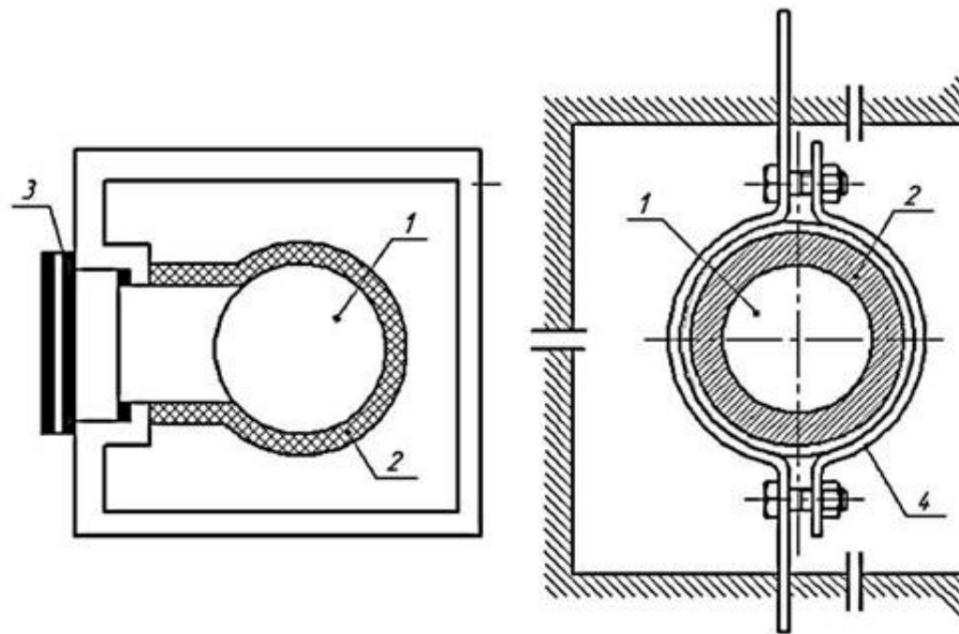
Схема звукоизоляции мусоропровода в жилом здании:
